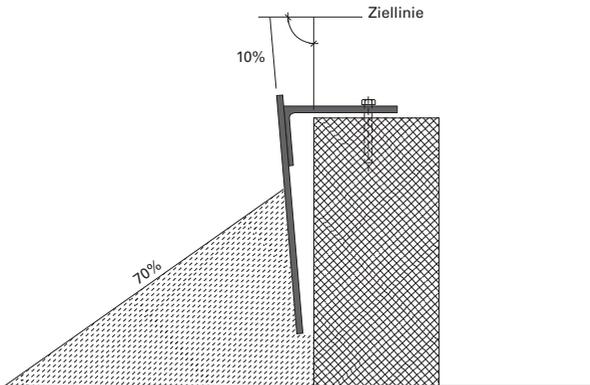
Mauerbrüstung mit vorschriftsgemäss befestigter Prellplatte
